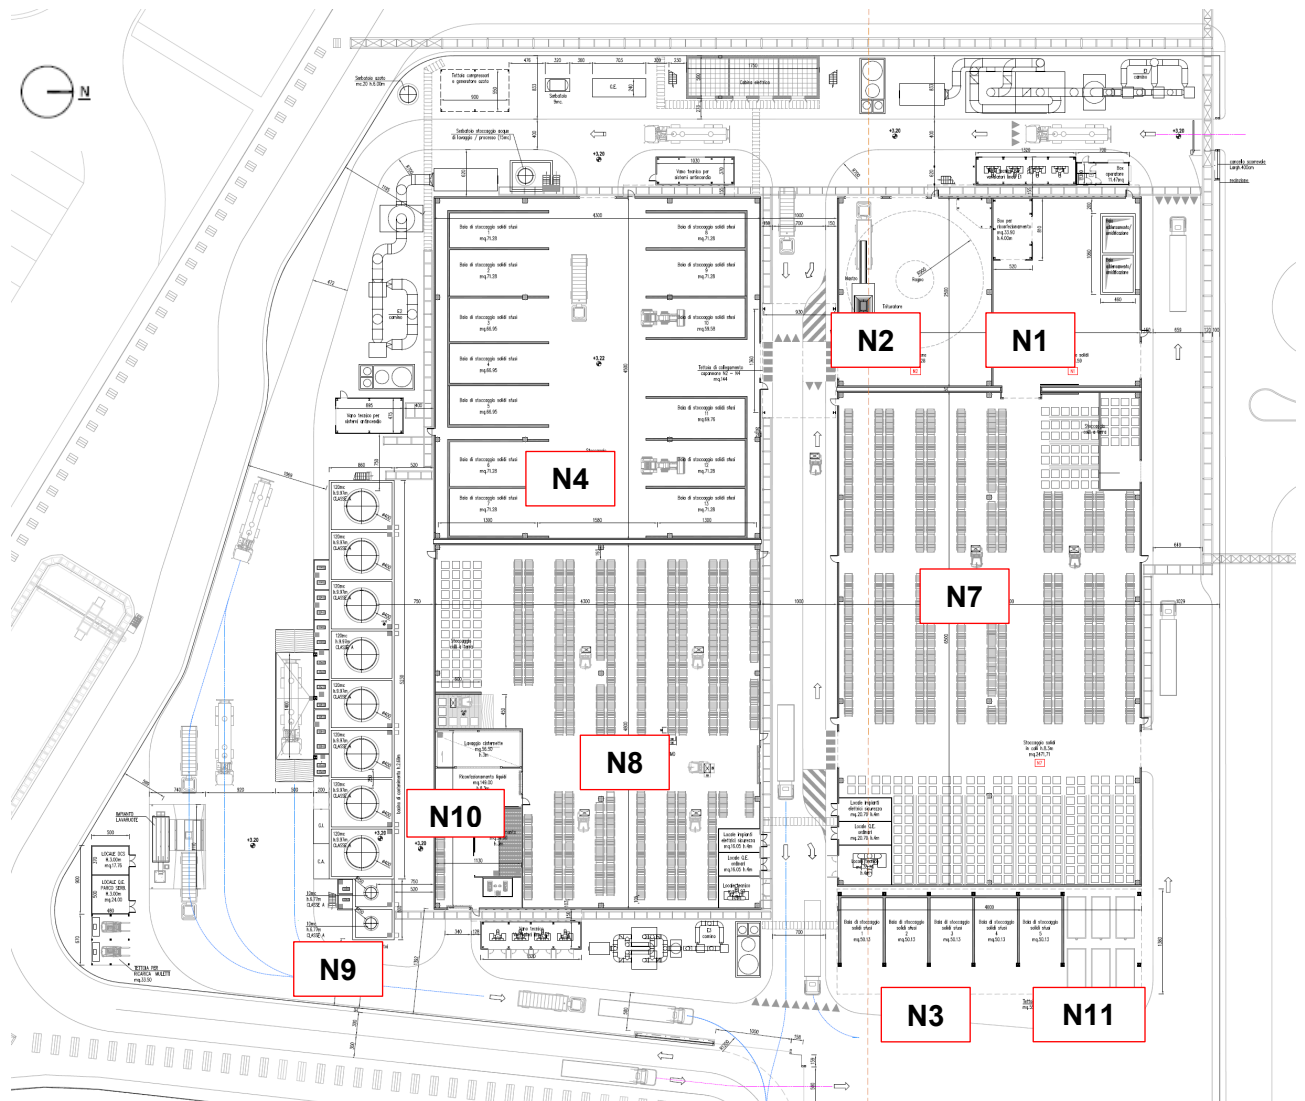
Stralcio della planimetria generale (CO 05 RA VA 01 D1 PL 49.00 - LAYOUT GENERALE PIATTAFORMA). Dettaglio sezioni in progetto.
